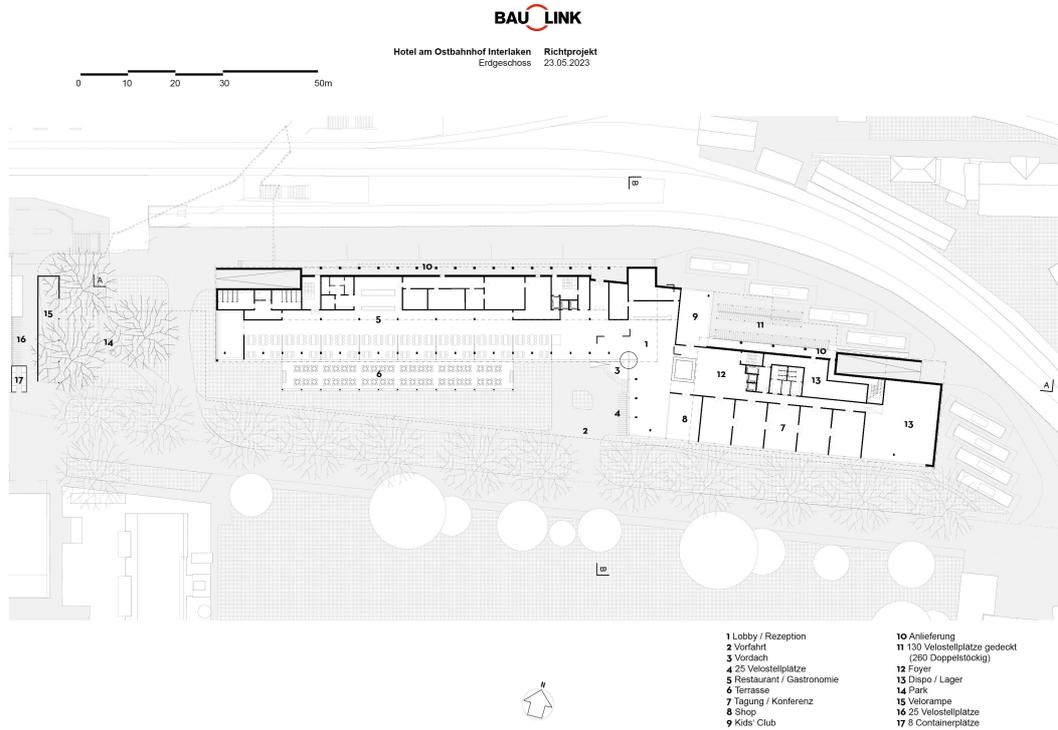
Ausschnitt Plan Erdgeschoss aus Richtprojekt, Baulink AG, 2023
